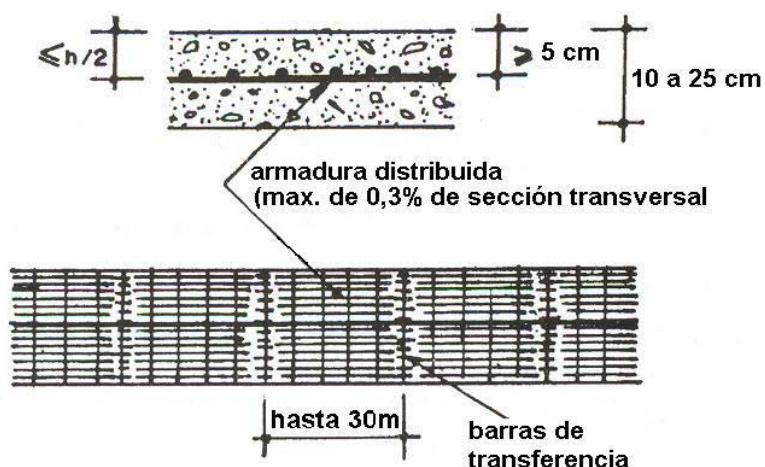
Pavimentos de Concreto con Refuerzo de Acero no Estructural.
